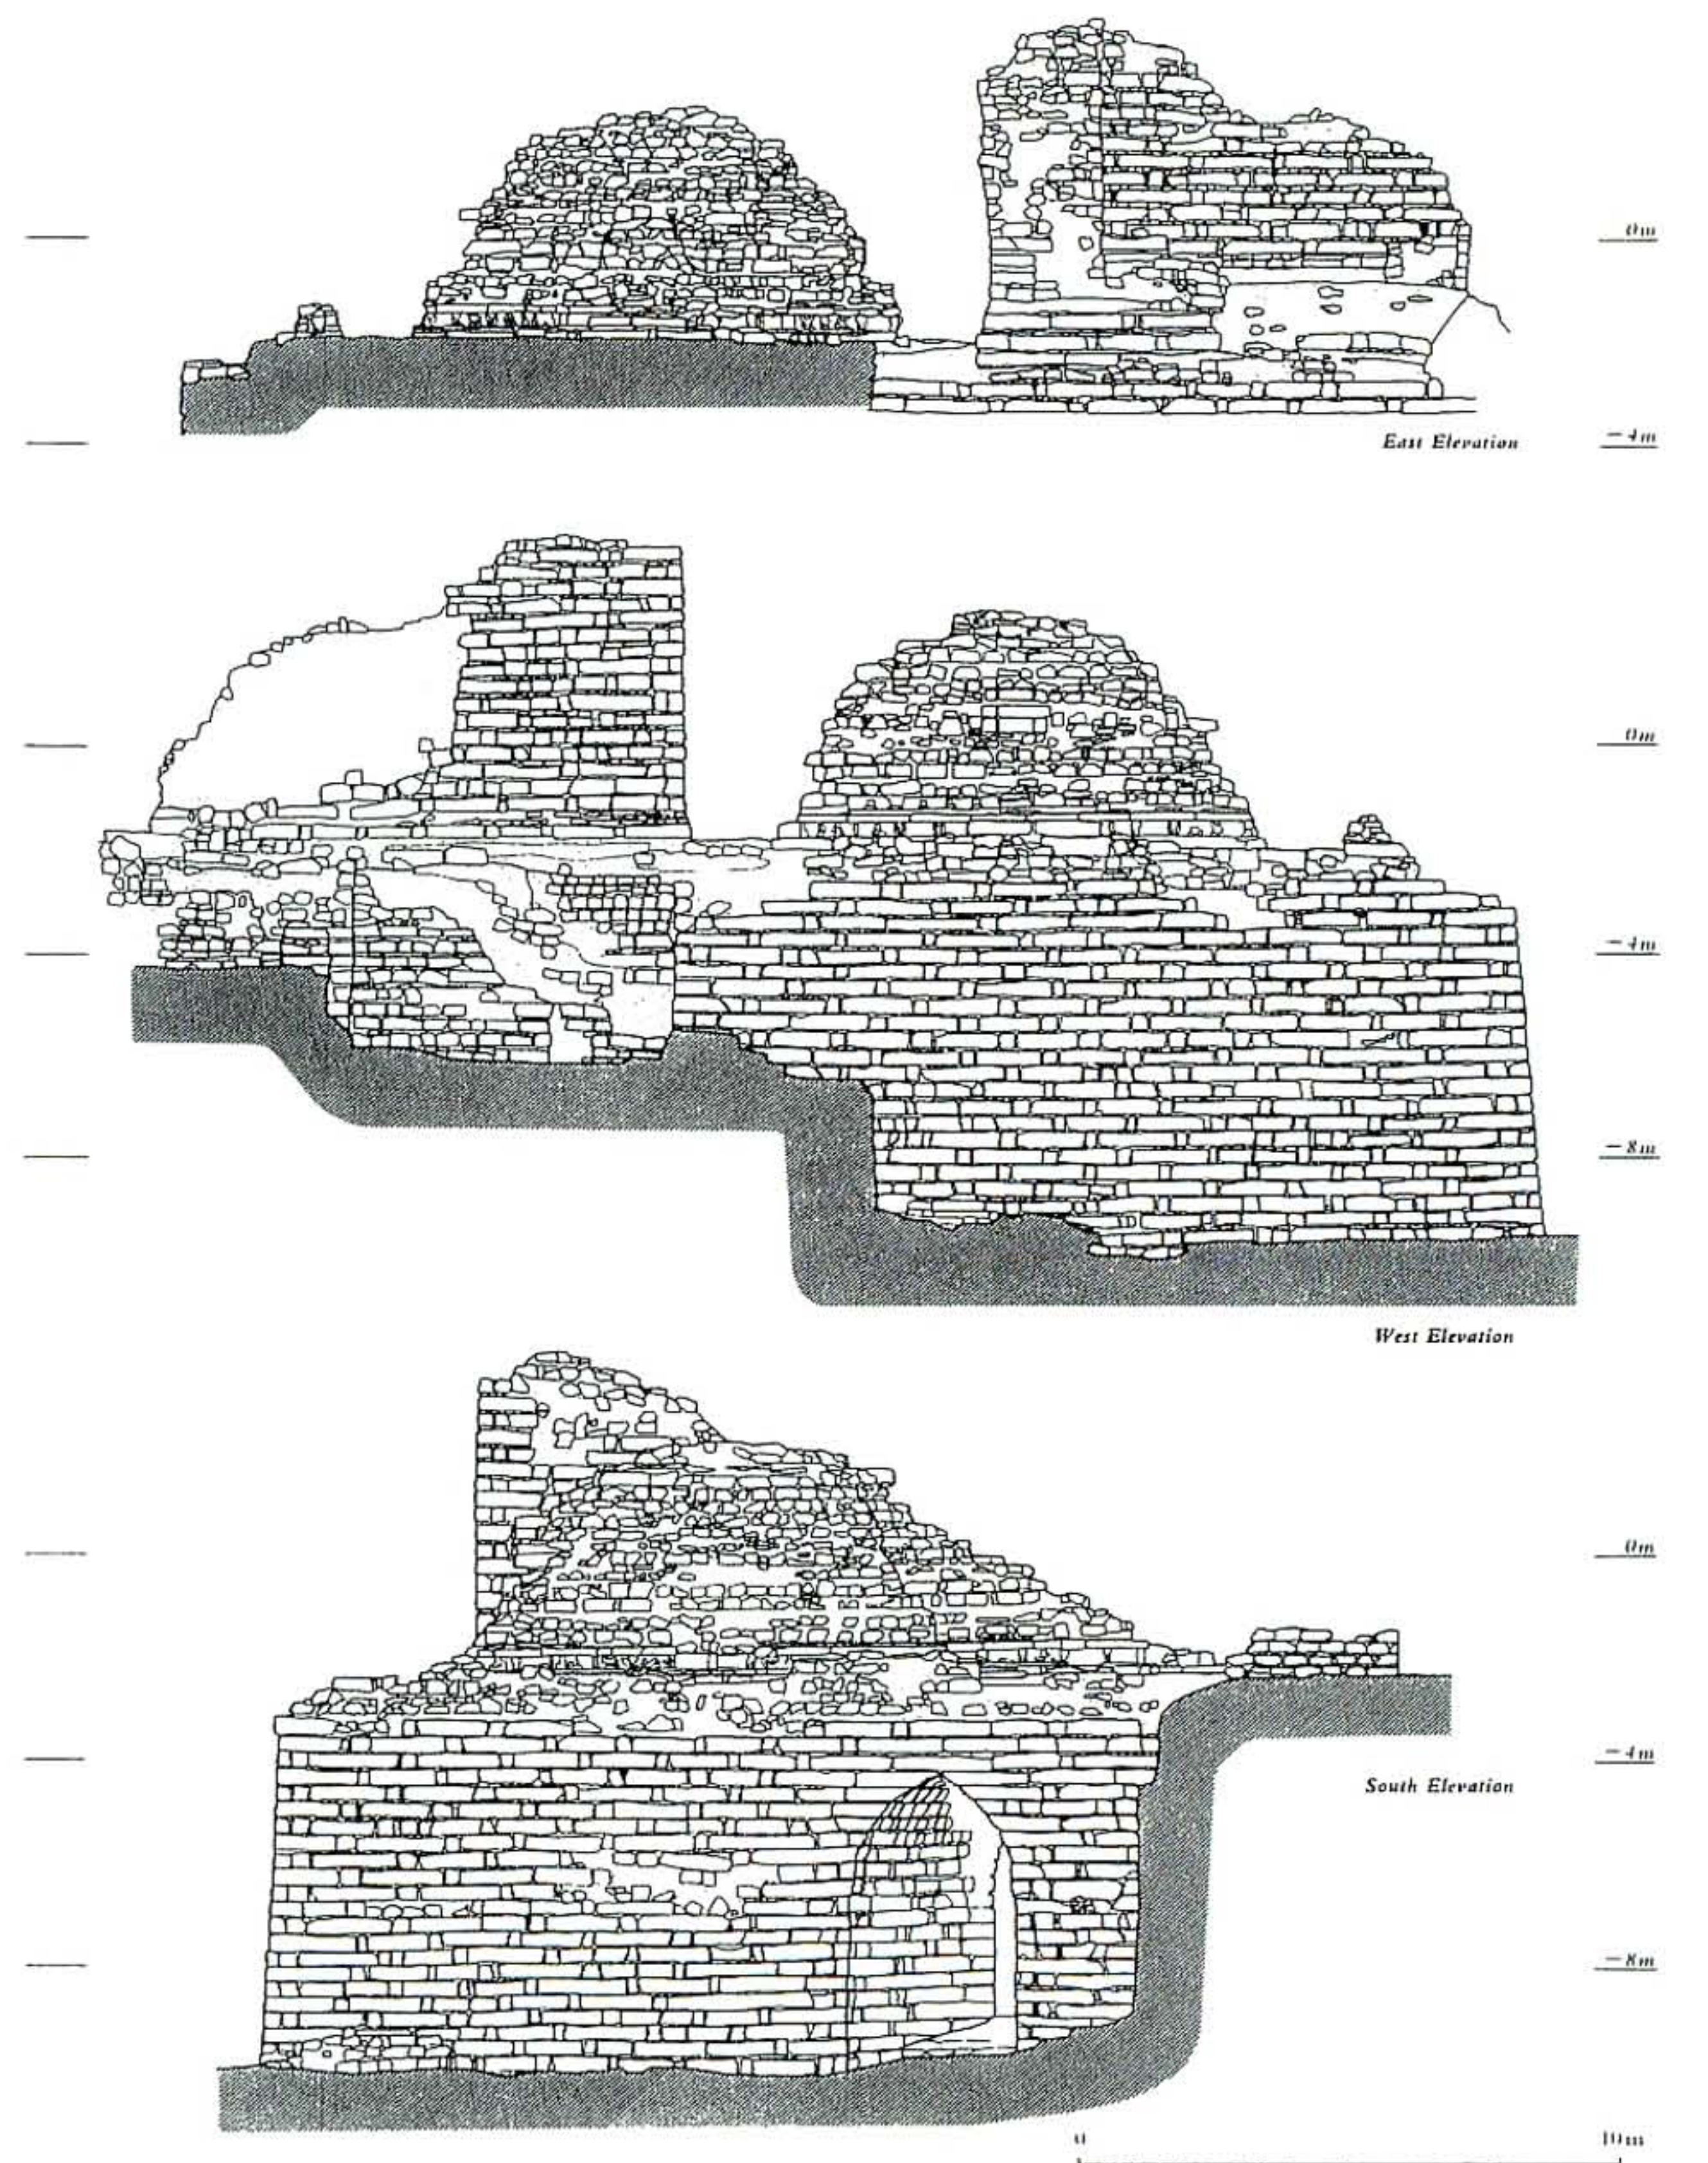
西南塔と西南祠堂 立面図 South-west Stupa St. 301 and South-west Shrine R. 301, Elevations
